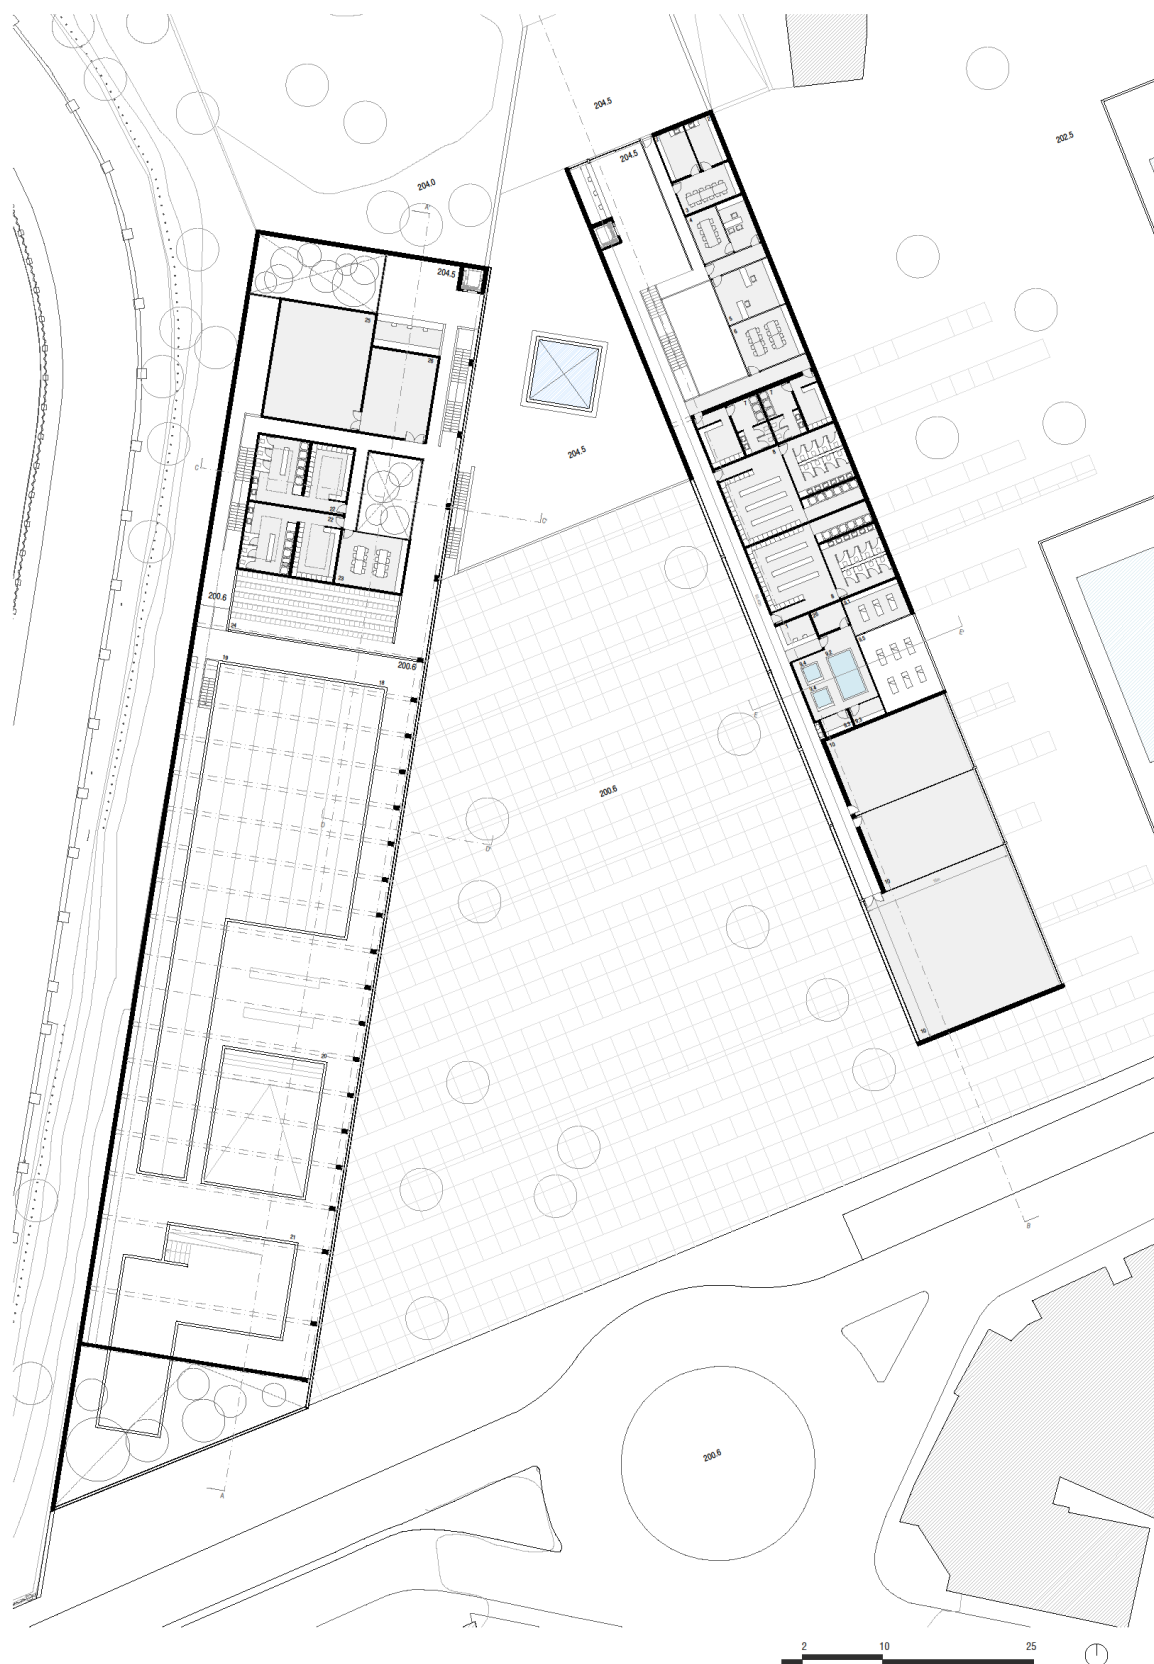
Proposta: Planta Piso 1, Fonte: Autor
